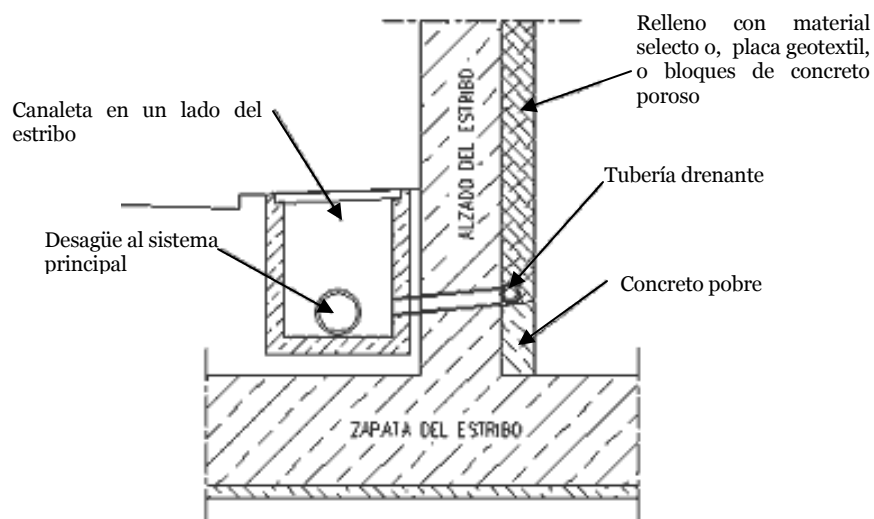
f Ejemplo de drenaje normal de trasdós de estribo
